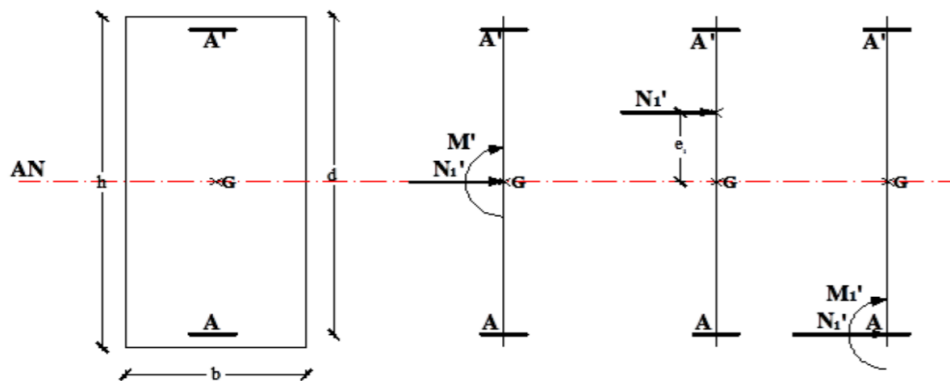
Position de N'_1 , M'_1 et M_1 sur la section transversale.
